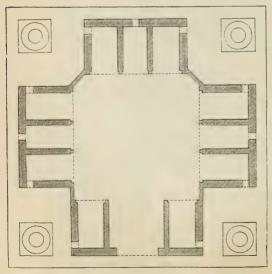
Grundriß zu einem 22fächerigen Pavillon.
